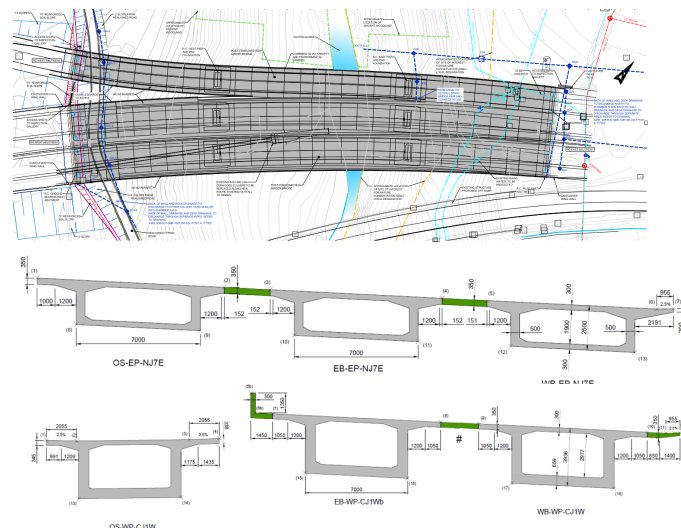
Planta general y secciones transversales en la zona de doble cajón y de triple cajón
